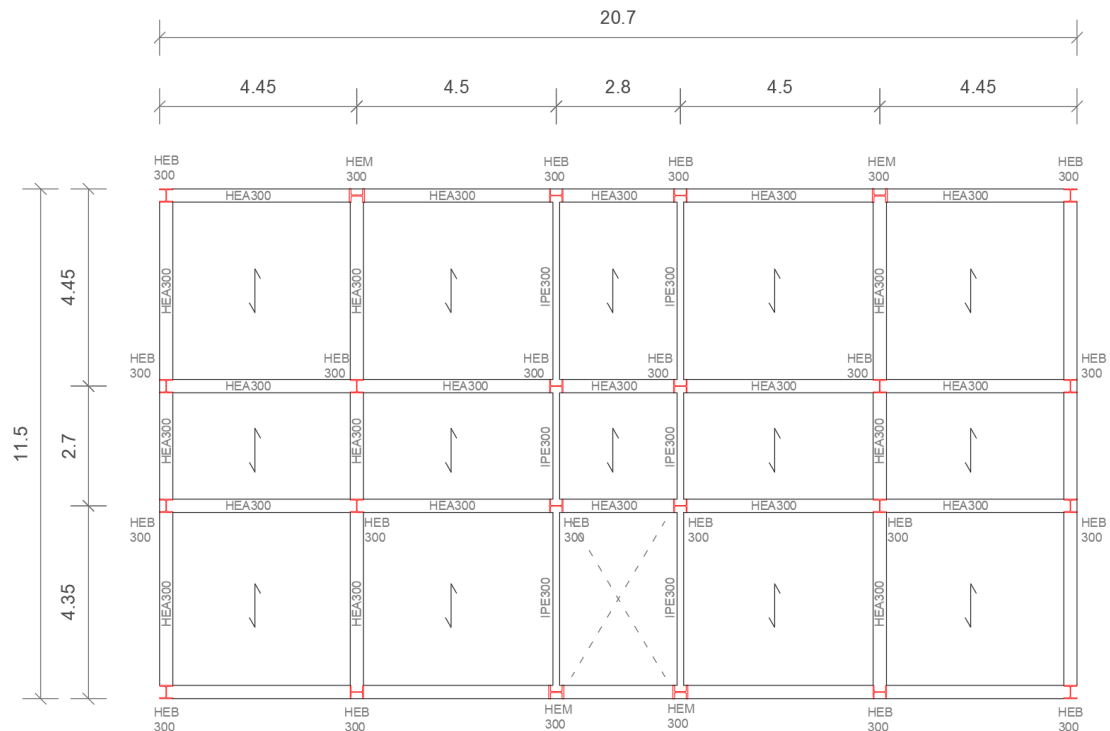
Carpenteria primo solaio struttura in acciaio a due piani.
